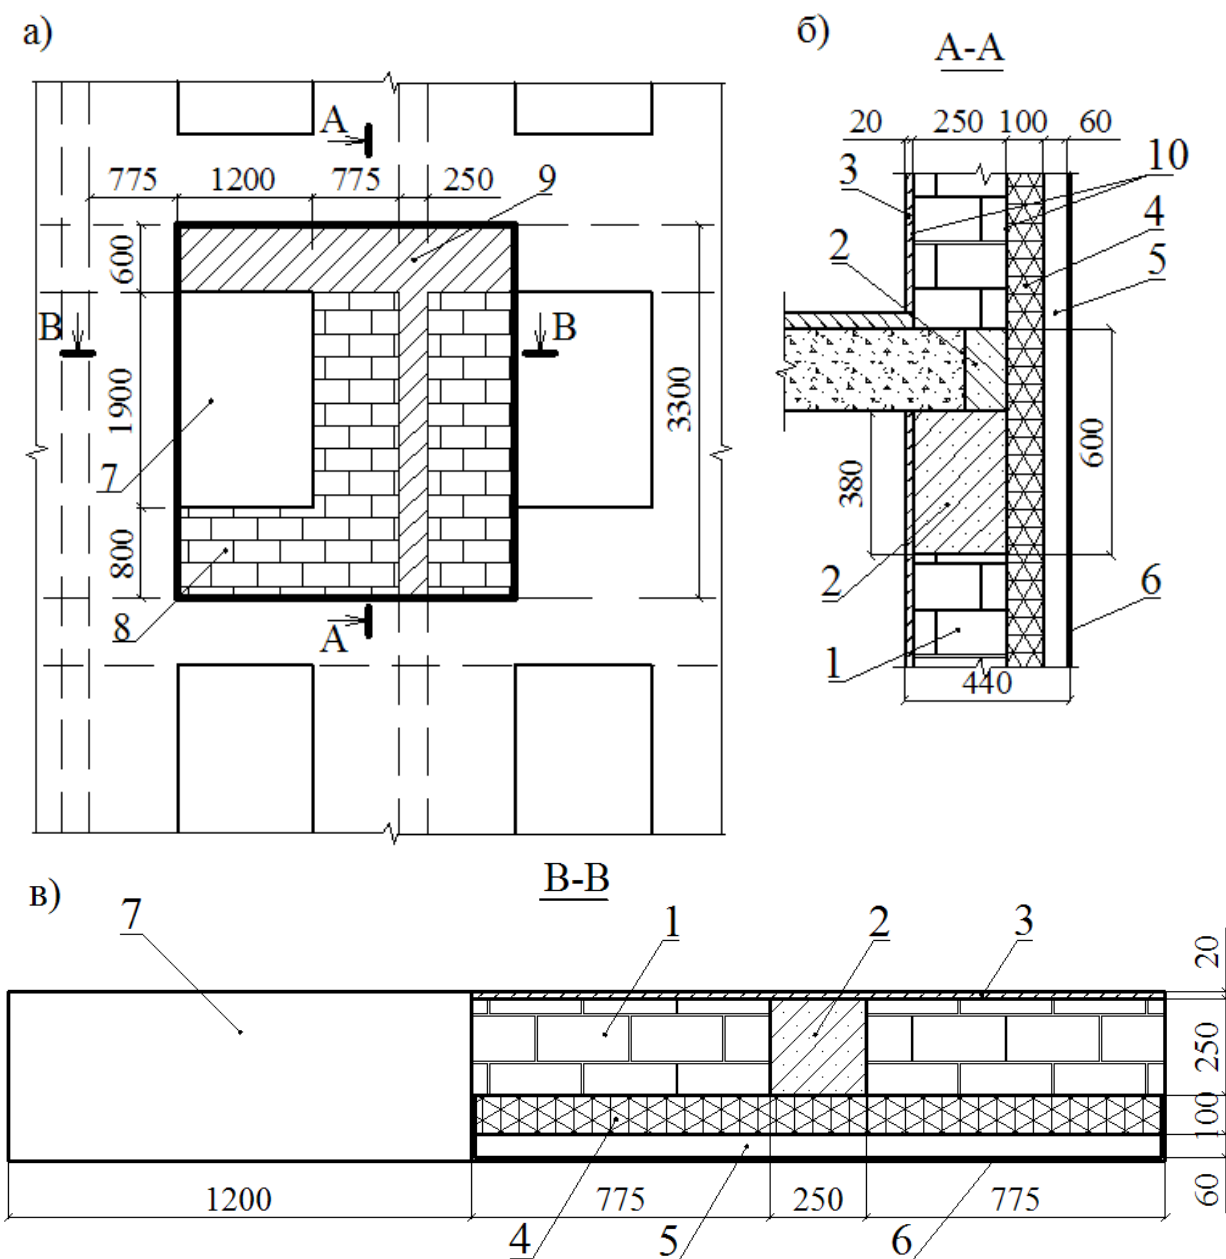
Модульный фрагмент фасада здания (а) и его сечения А-А (б) и В-В (в)
